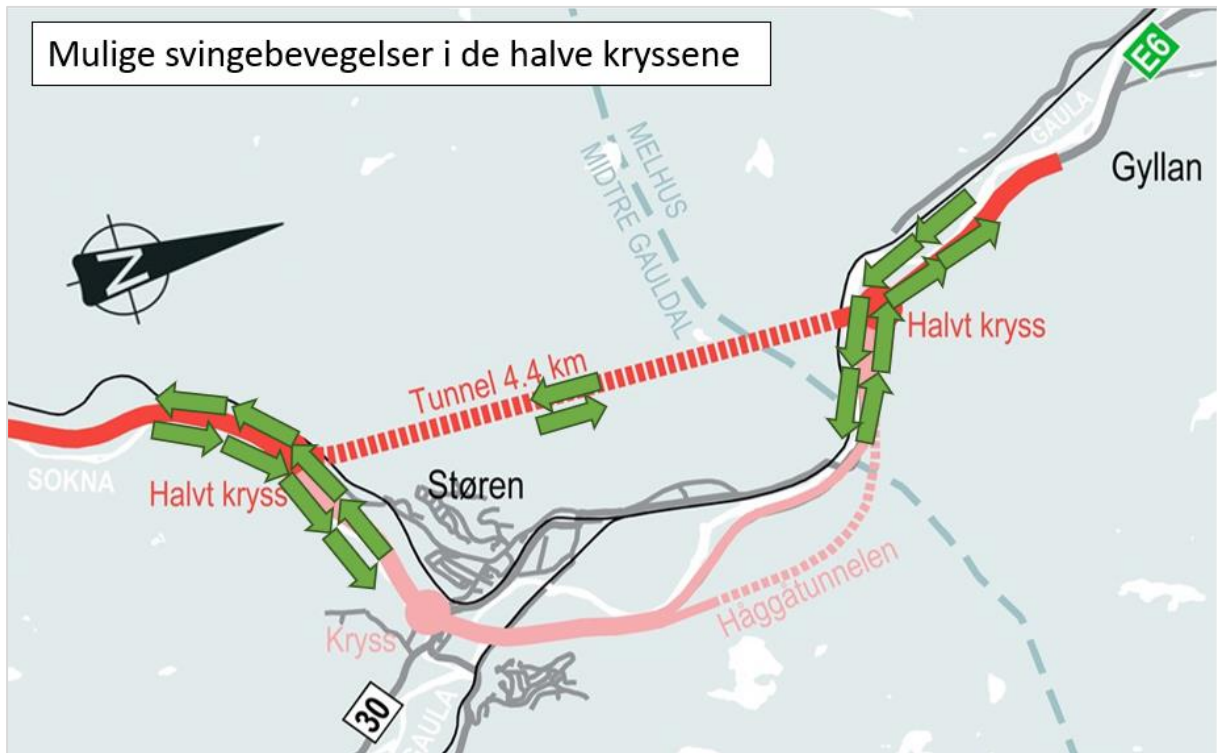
Tunnelalternativ for E6 ved Støren, hvor E6 går i tunnel gjennom Mannfjellet.
